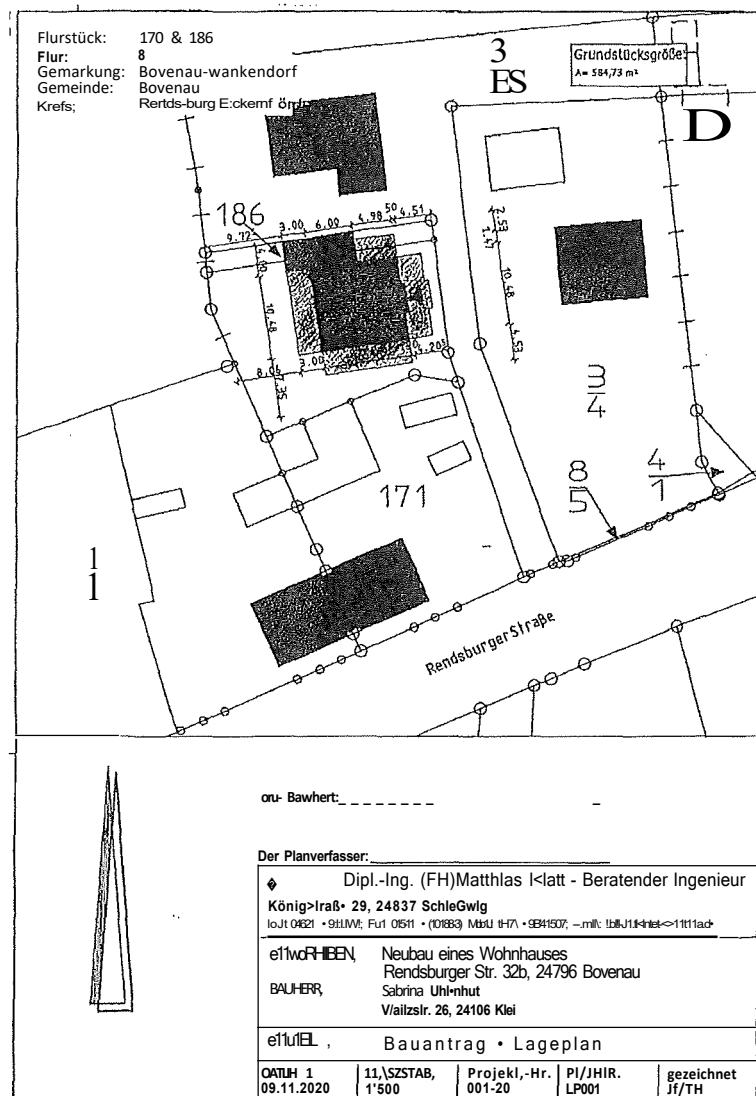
Lageplan des Grundstückes Rendsburger Straße 32b in 24796 Bovenau mit dem vorgesehenen Standort des geplanten Einfamilienhauses mit Carport
